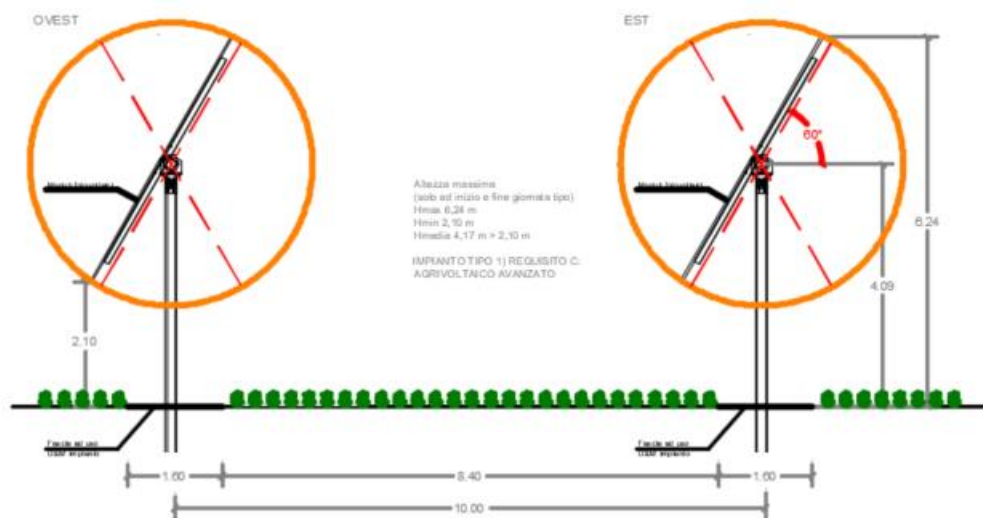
Sezione tipo Struttura tracker e mutue distanze tra le strutture
